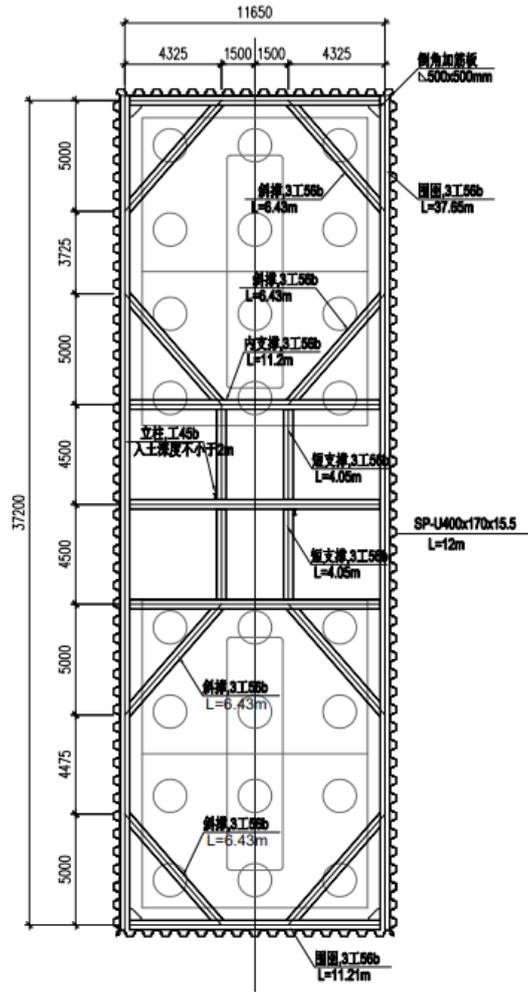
四侧钢板桩围檩支撑平面图
